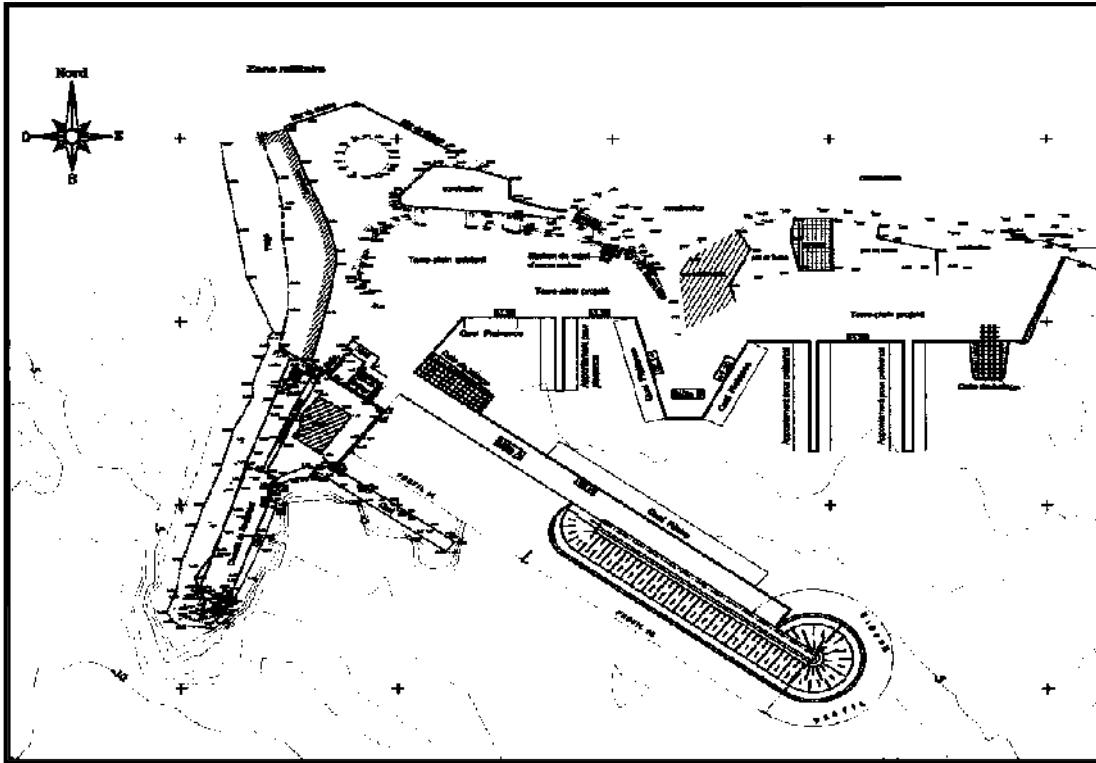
Plans de masse de la variante 2 proposées (L.E.M.2007)
